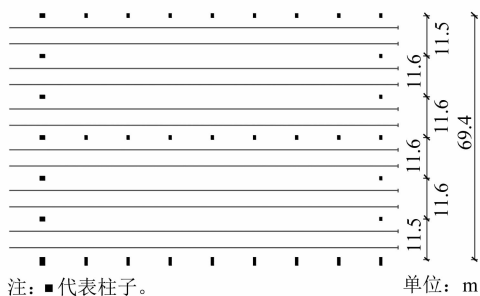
架空及全上盖物业开发条件下湖涌停车场总平面布置图
